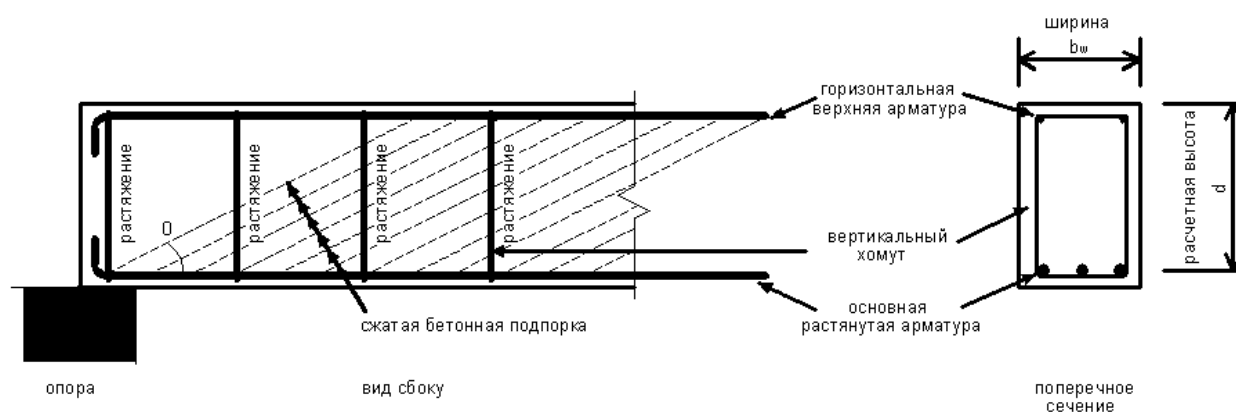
Опорная часть балки, воспринимающая поперечную силу: растянутые хомуты и сжатые бетонные подпорки
